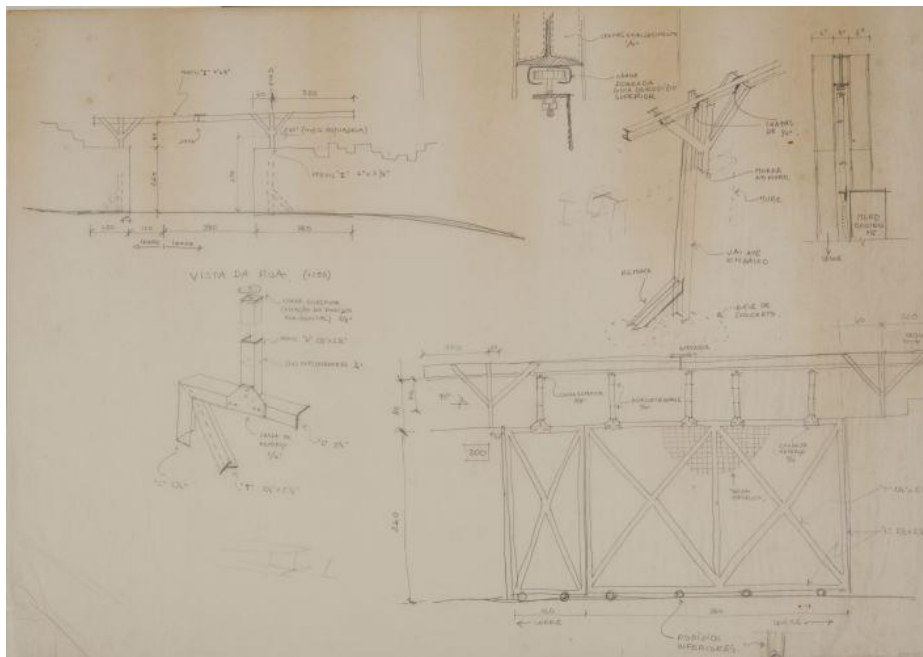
Croquis del corte y detalle estructura de la elevación de la puerta de acceso, s.f. (Autora: Lina Bo Bardi).
